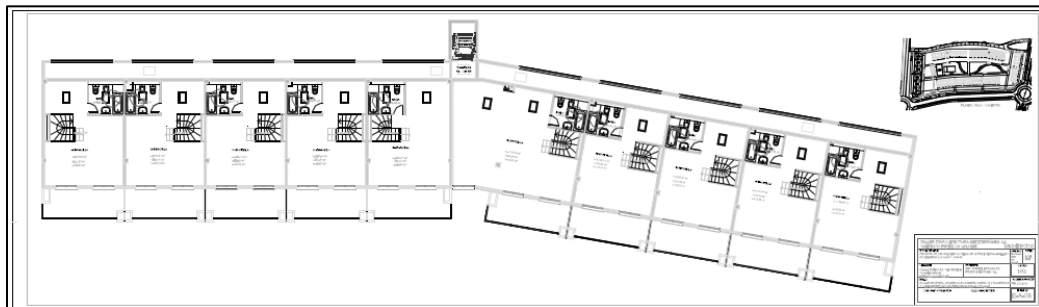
Juntas 15, 16 y 17- Planta bajo cubierta. Fuente propia
